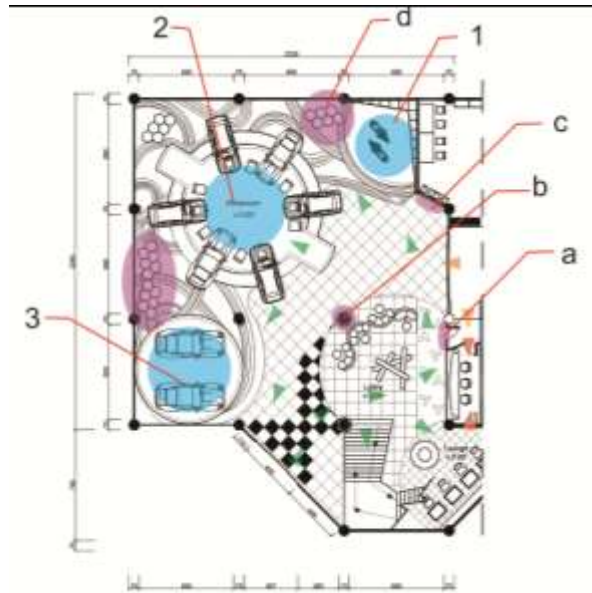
Denah R. Lobby dan Area Pamer (Showroom)
